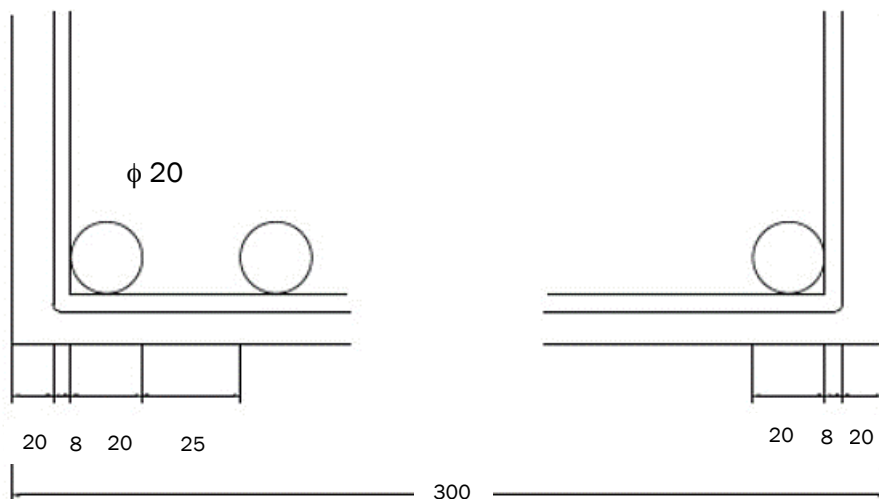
Cálculo del número de barras en la sección de la viga 1. Fuentes: Elaboración propia.
